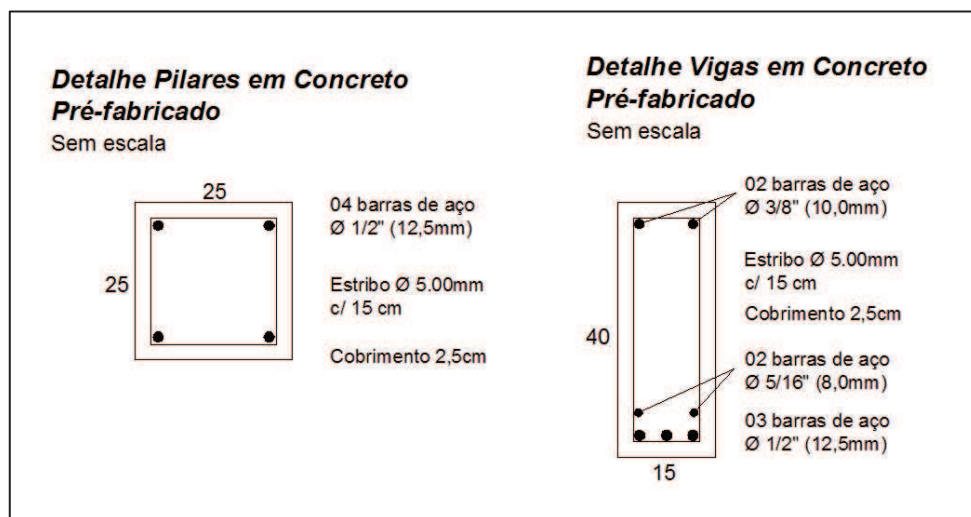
Detalhe seção vigas e pilares- Modelo Principal.
